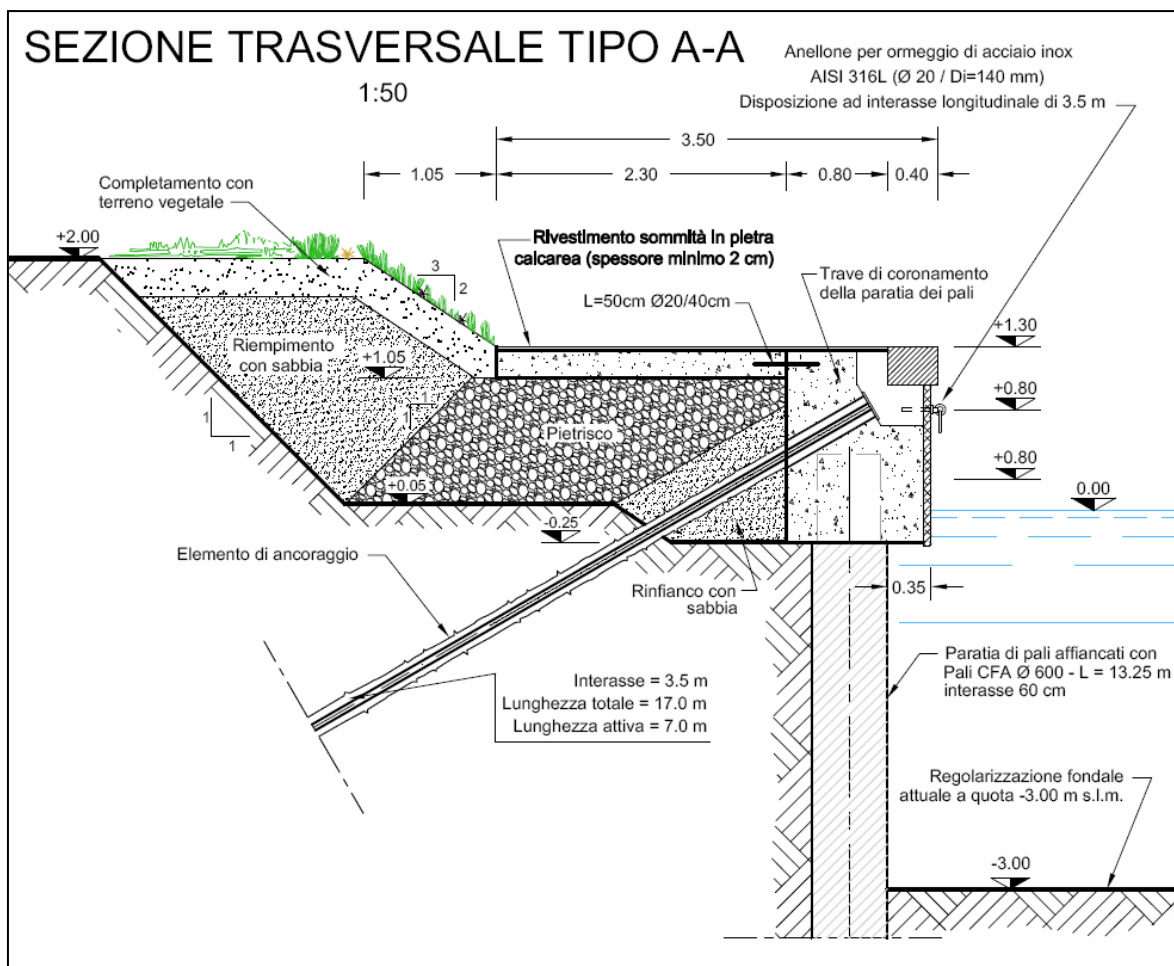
Sezioni tipo delle strutture di sistemazione delle sponde a parete verticale (banchine)
